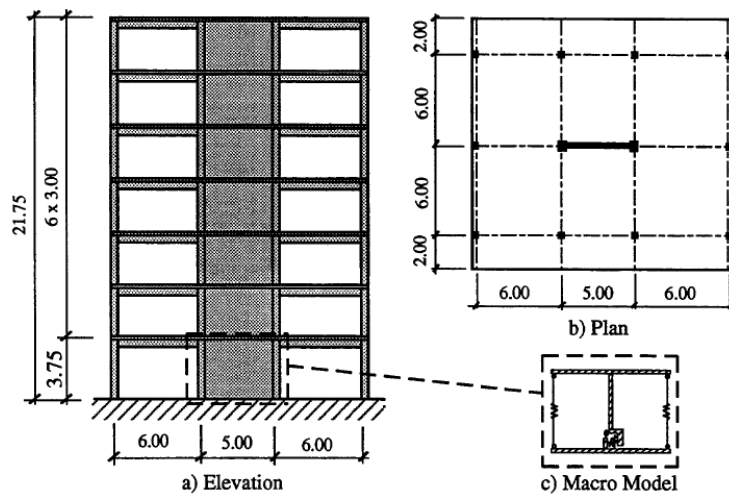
Estructura ensayada de siete plantas con muros y pórticos [Kabeyasawa et al., 1983]
